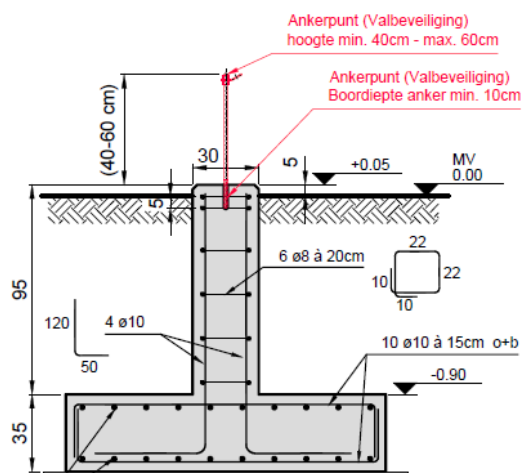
Valbeveiligingssysteem 1 met betonnen funderingssokkel:
